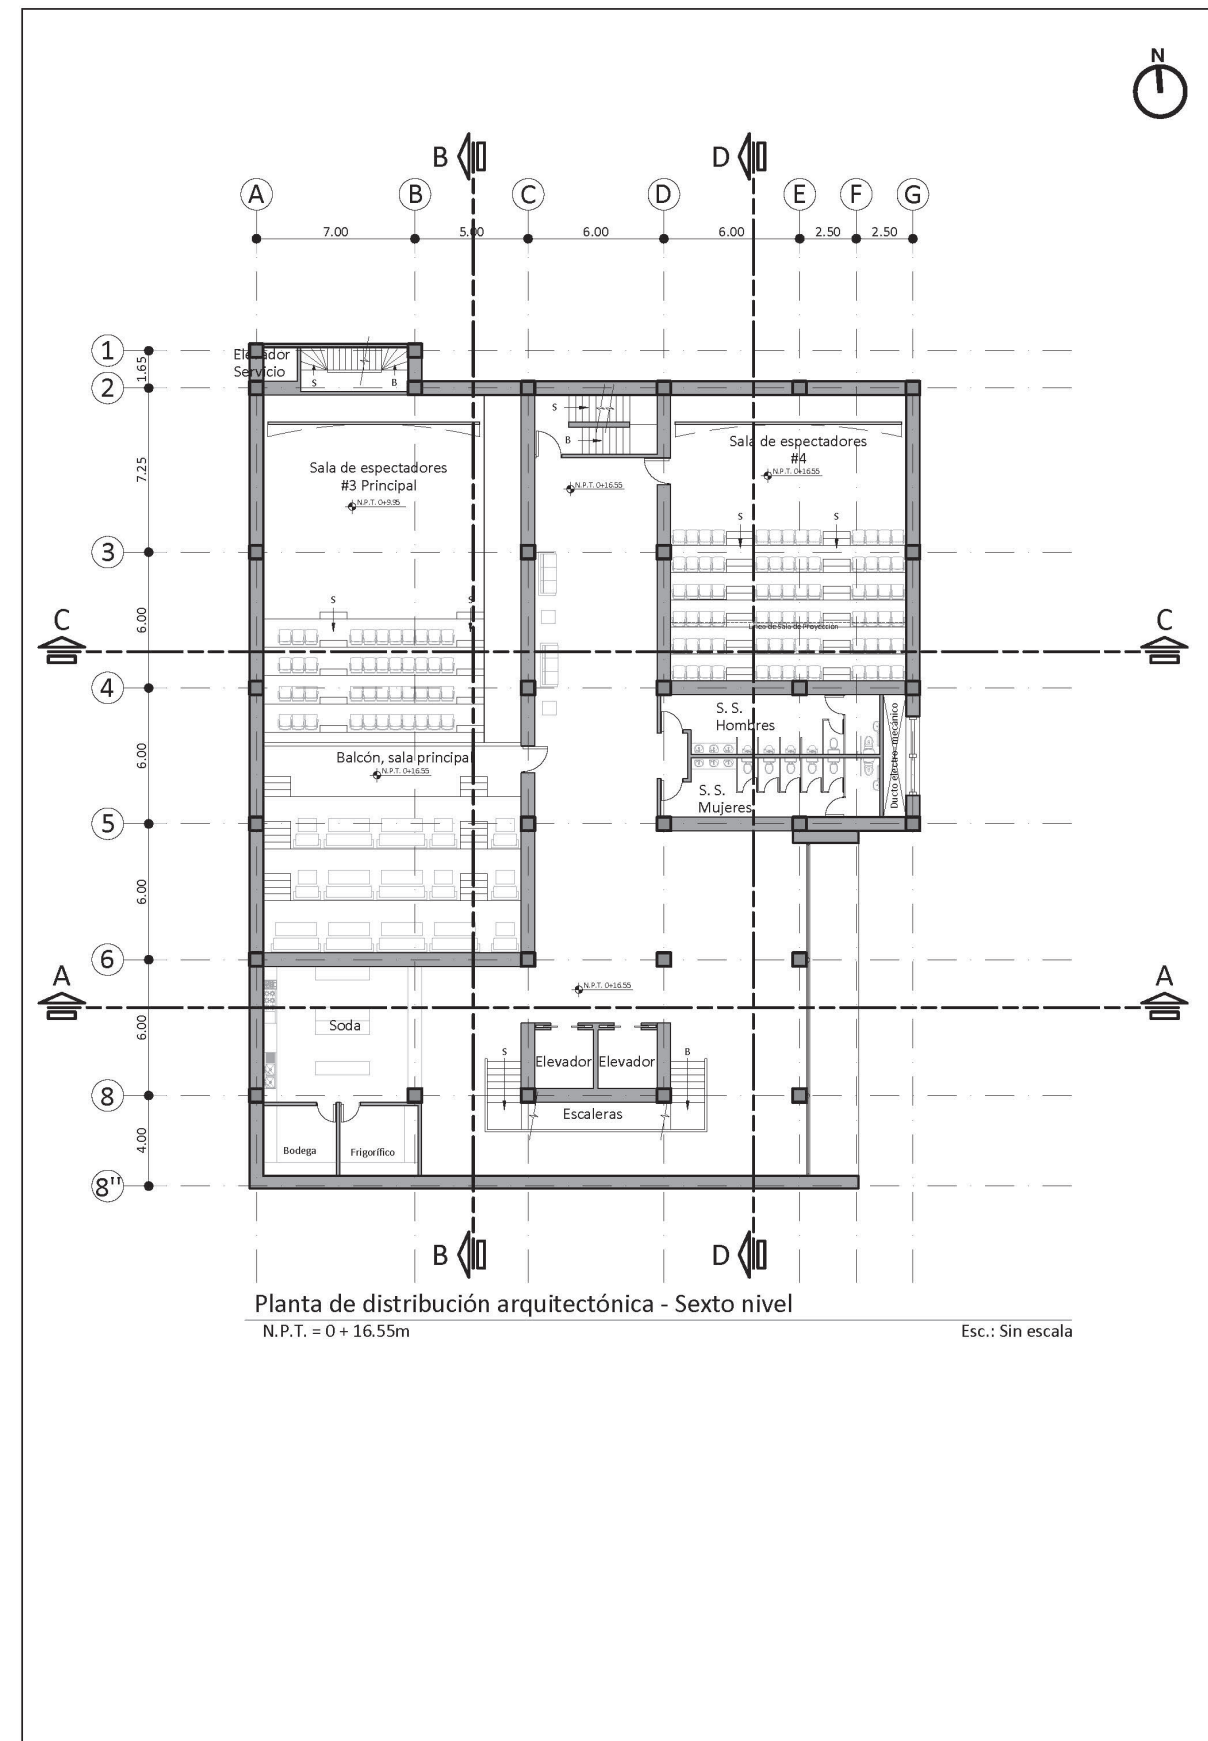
Planta de distribución arquitectónica de sexto nivel. Fuente: Propia.
